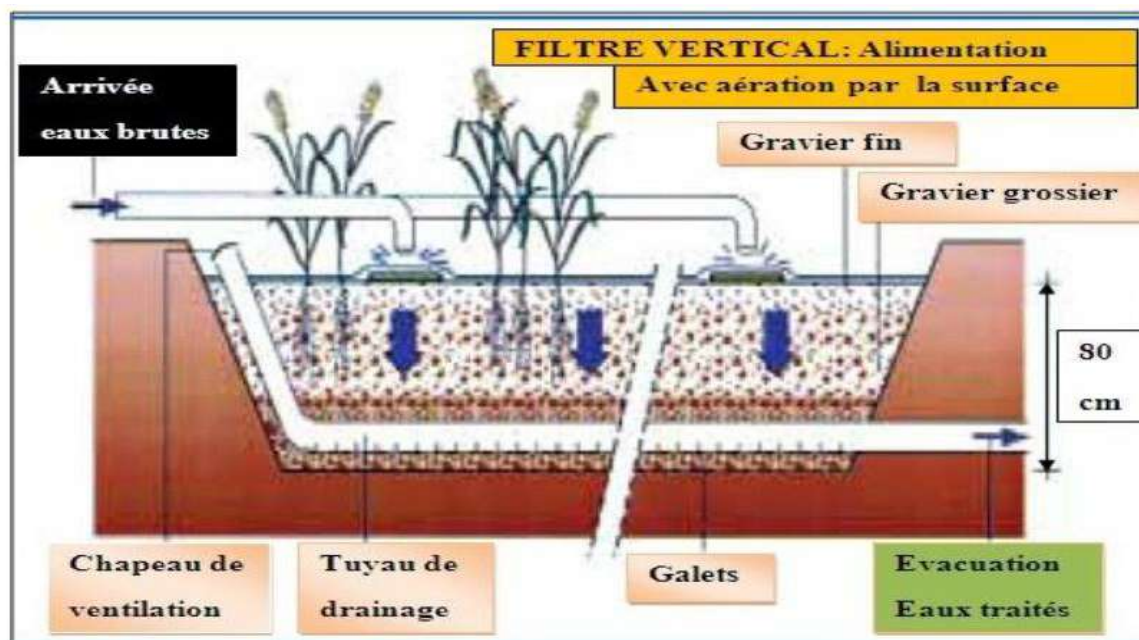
Coupe transversale d'un filtre planté à écoulement vertical.
